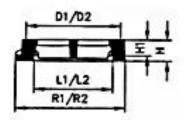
ist passend zu Betonschachtrahmen LU/U
